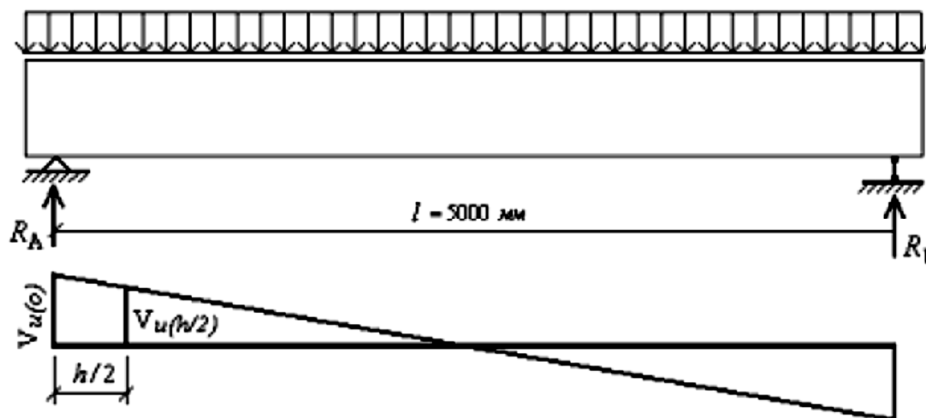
Répartition des armatures transversales suivant la longueur de la poutre
